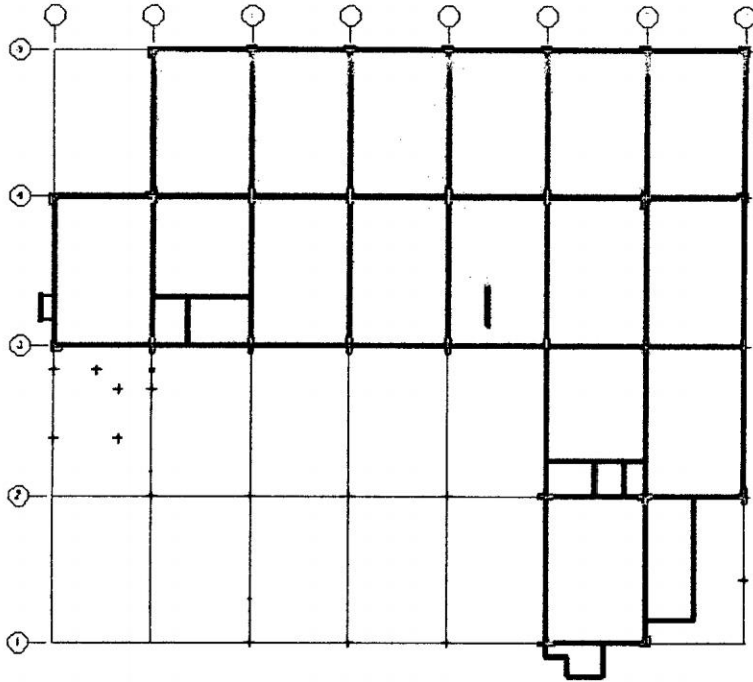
Losa aligerada del sótano de la Biblioteca UNSCH
